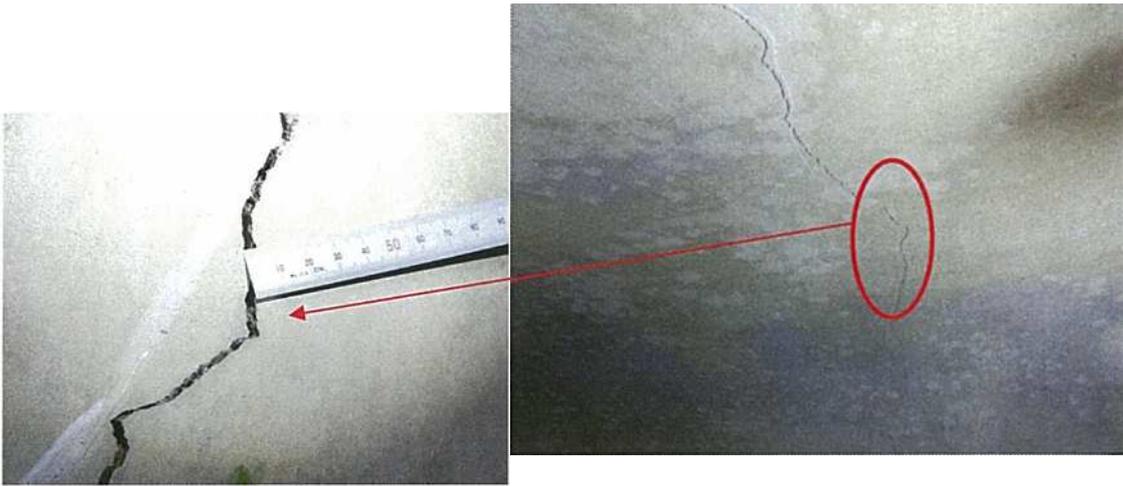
覆エスパンの中間付近に発生したひび割れの例¹⁾
